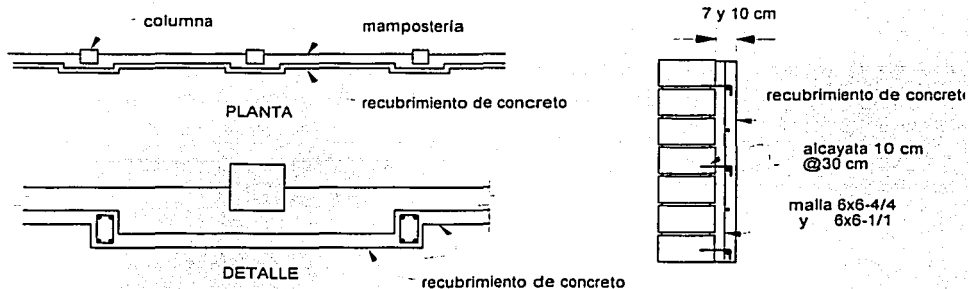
Detalles del refuerzo del proyecto no. 4
